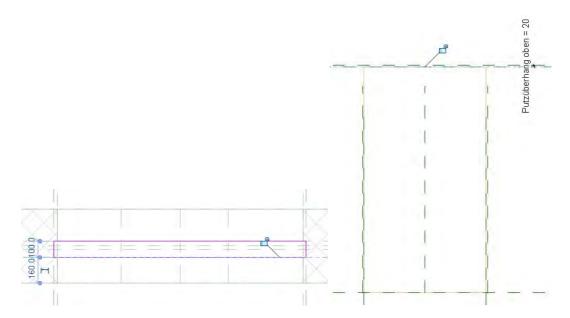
Ausrichten der Extrusion im Grundriss (links) und in der Ansicht (rechts). In diesem Fall wird im Grundriss die Form bestimmt und in der Ansicht die Höhe. Um die gewünschte Parametrik zu erreichen, muss die Form an den Referenzebenen gesperrt werden.
